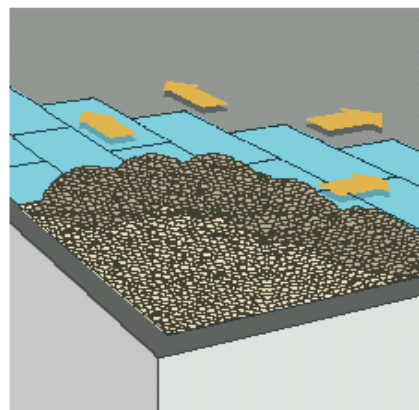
Ejemplo del orden en la instalación de planchas de XPS en cubierta plana invertida¹.
